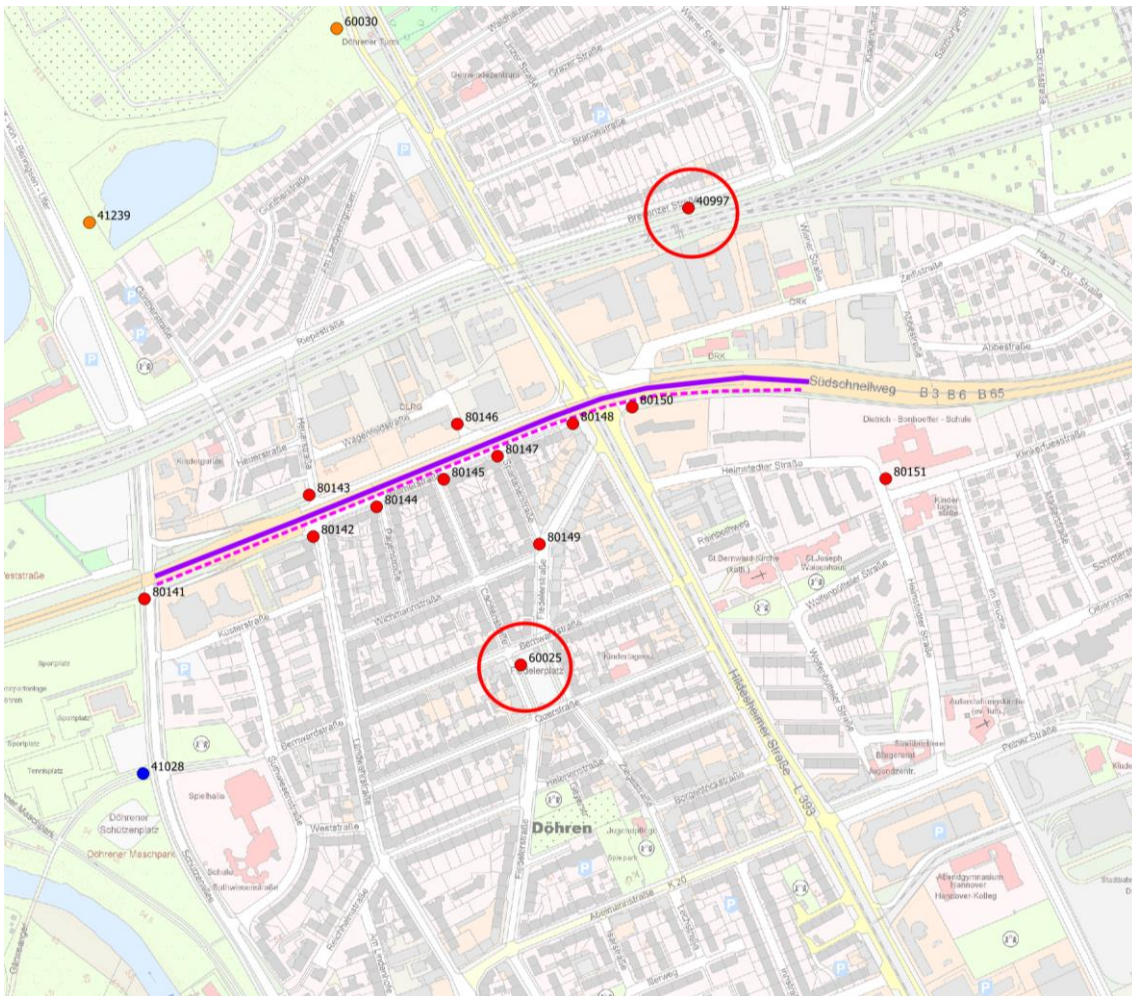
Lageplan mit Darstellung des geplanten Tunnels (violett) und der GWM im Umfeld. Die für die HGW-Berechnung an der Tunneltrasse verwendeten GWM sind rot umrandet.
